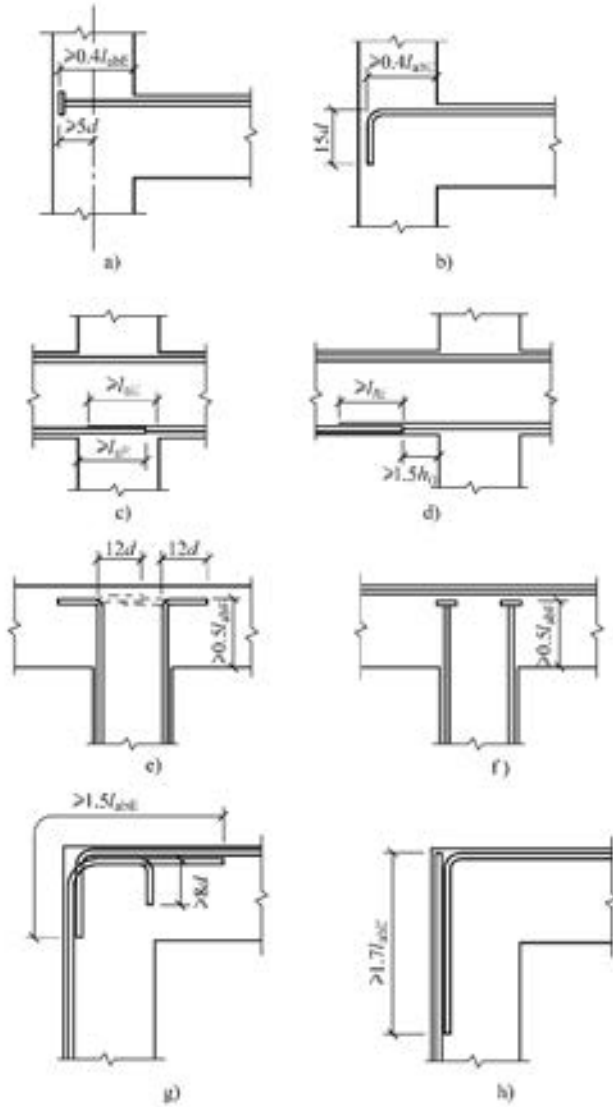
梁和柱的纵向受力钢筋在节点区的锚固和搭接
